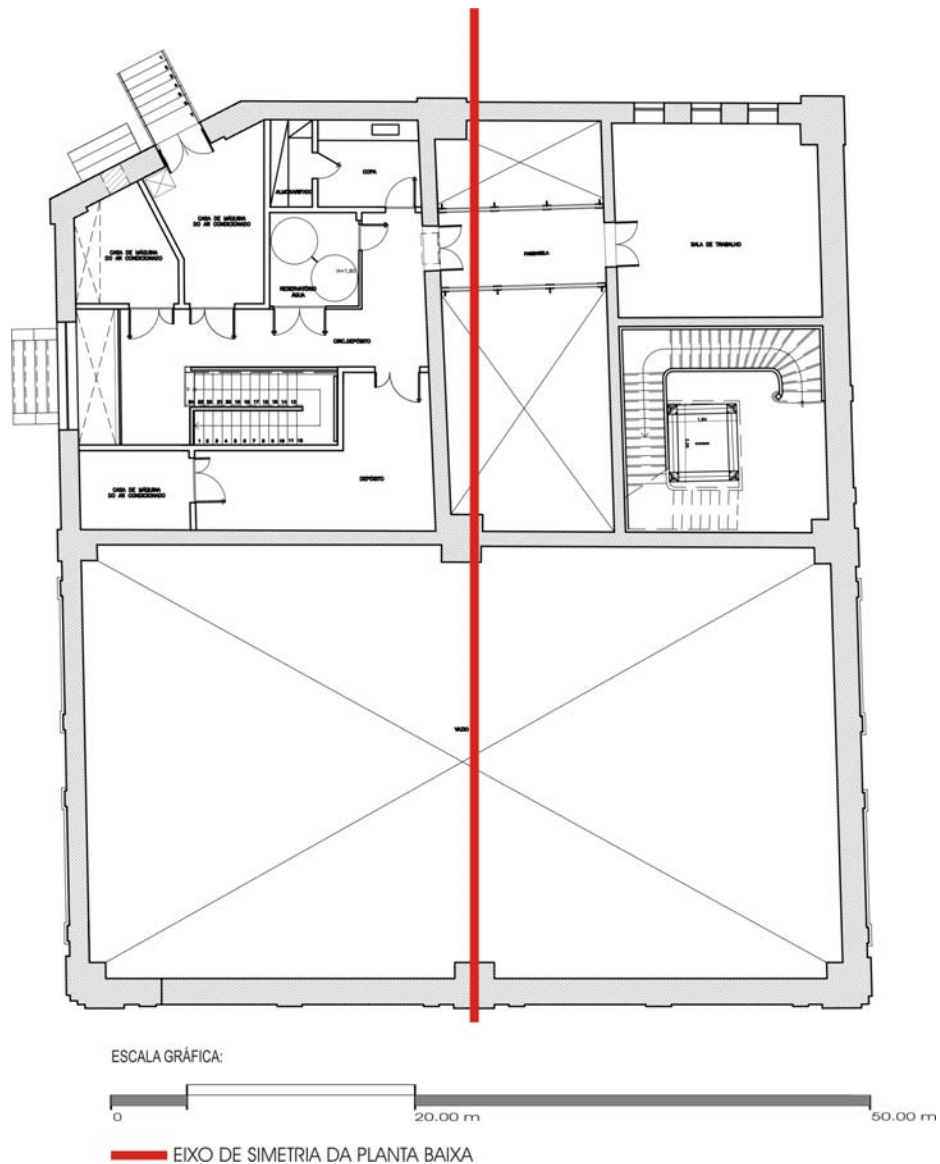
Planta baixa do pavimento intermediário – simetria da edificação.
